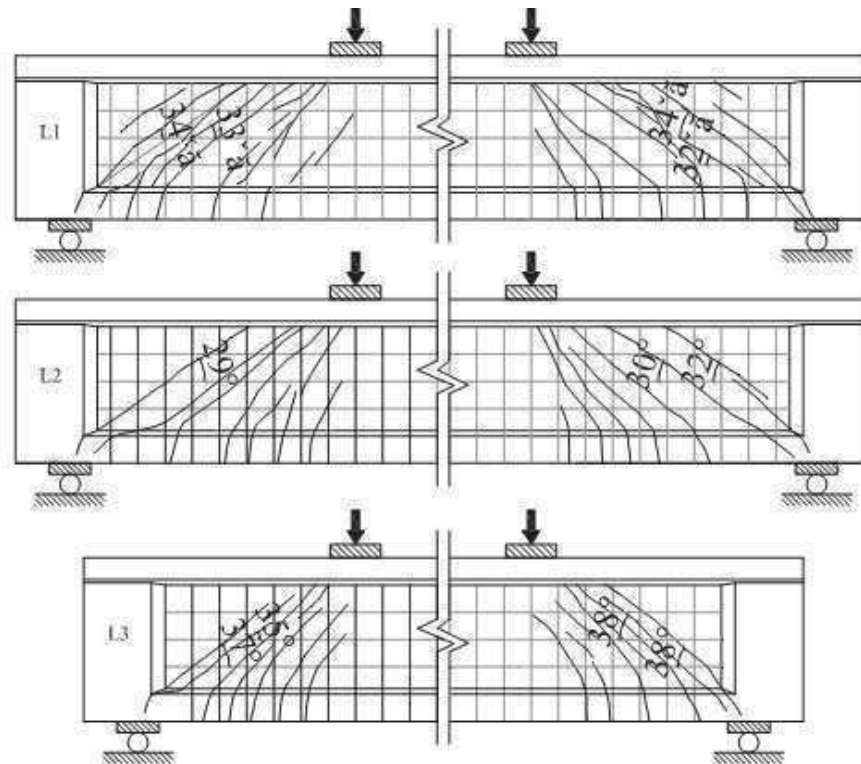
mode de fissuration des poutres en T [150].
